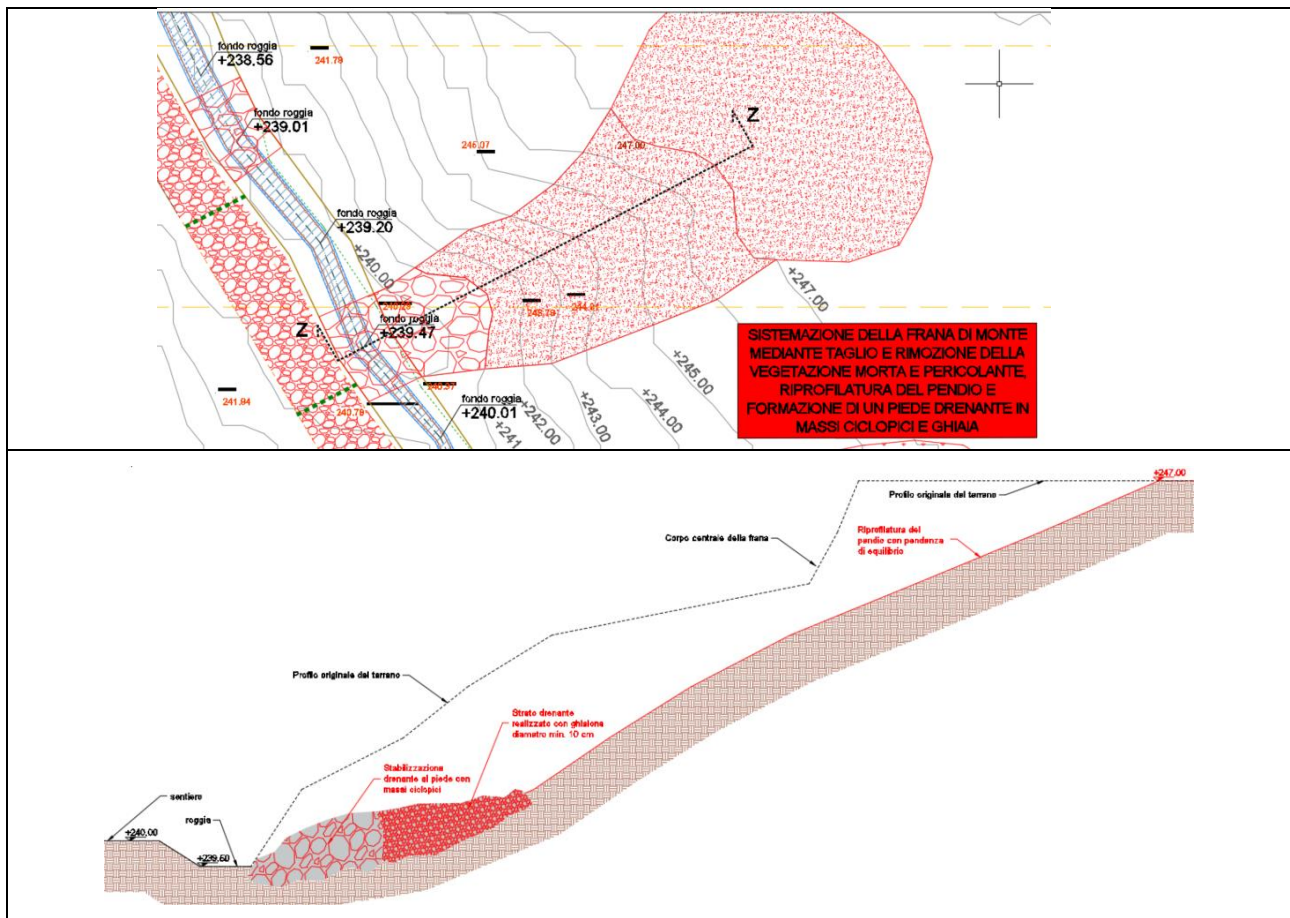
sistemazione della frana di monte: a) stralcio planimetrico; b) sezione trasversale
